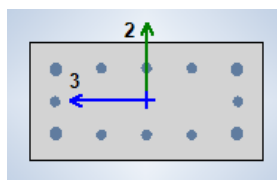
Secção transversal de um pilar da estrutura (ETABS).
